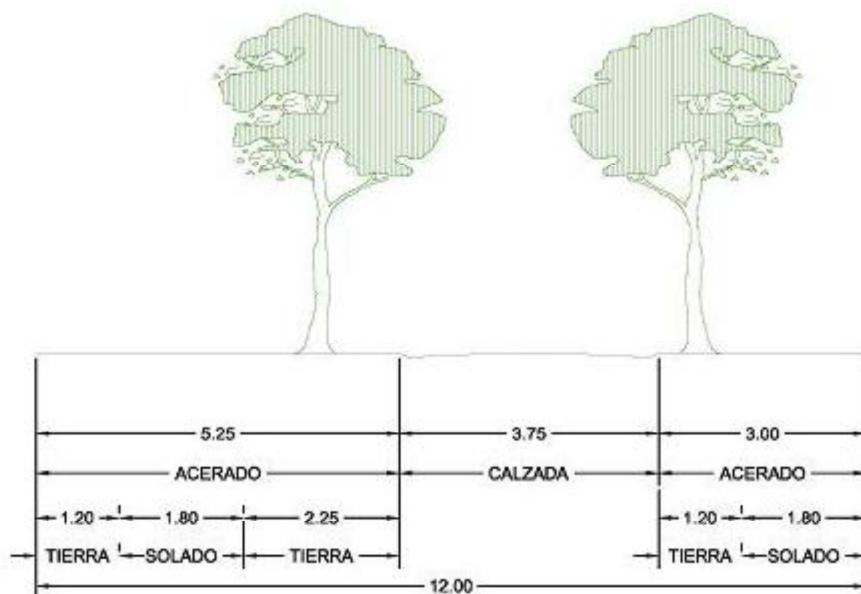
Sección viaria en zonas sin aparcamiento.
